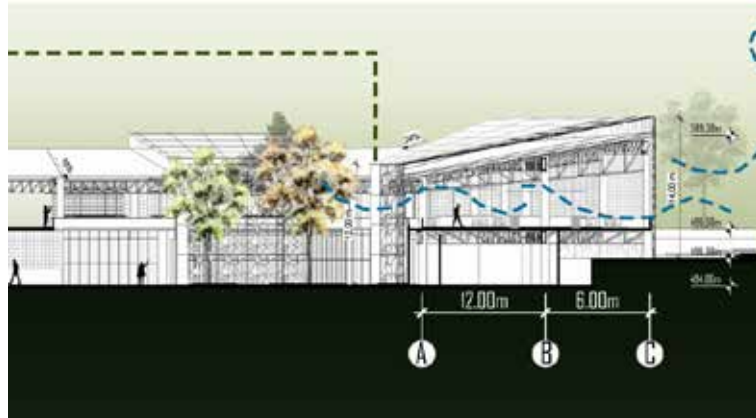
Sección transversal del proyecto donde se aprecia el sistema estructural. Fuente: Hernández y otros (2019).
